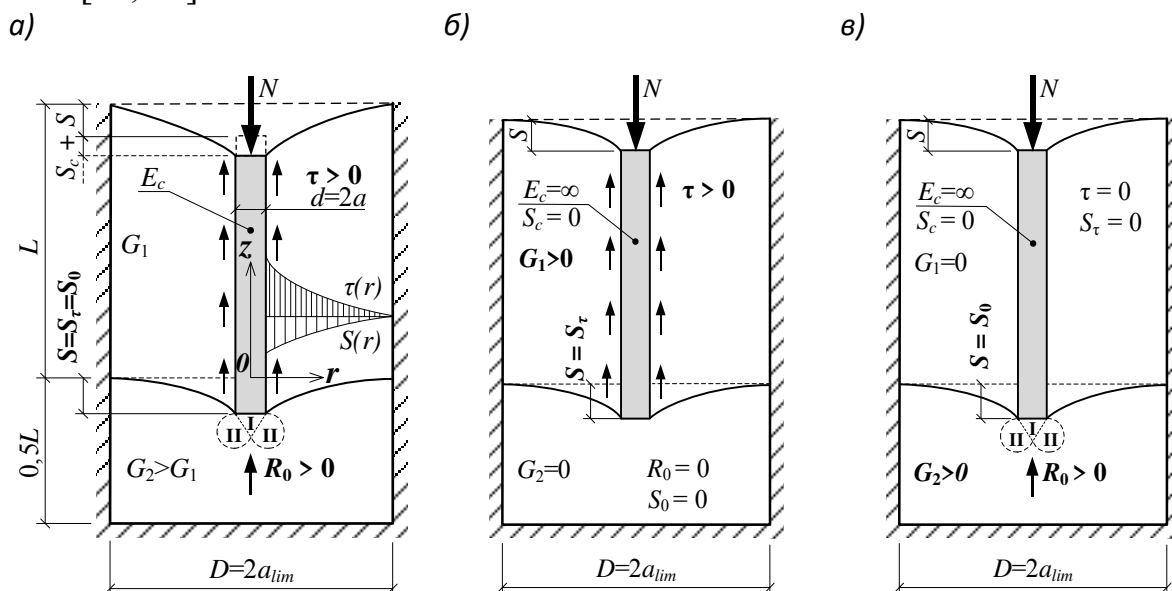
Схема двухслойной цилиндрической модели сваи:
